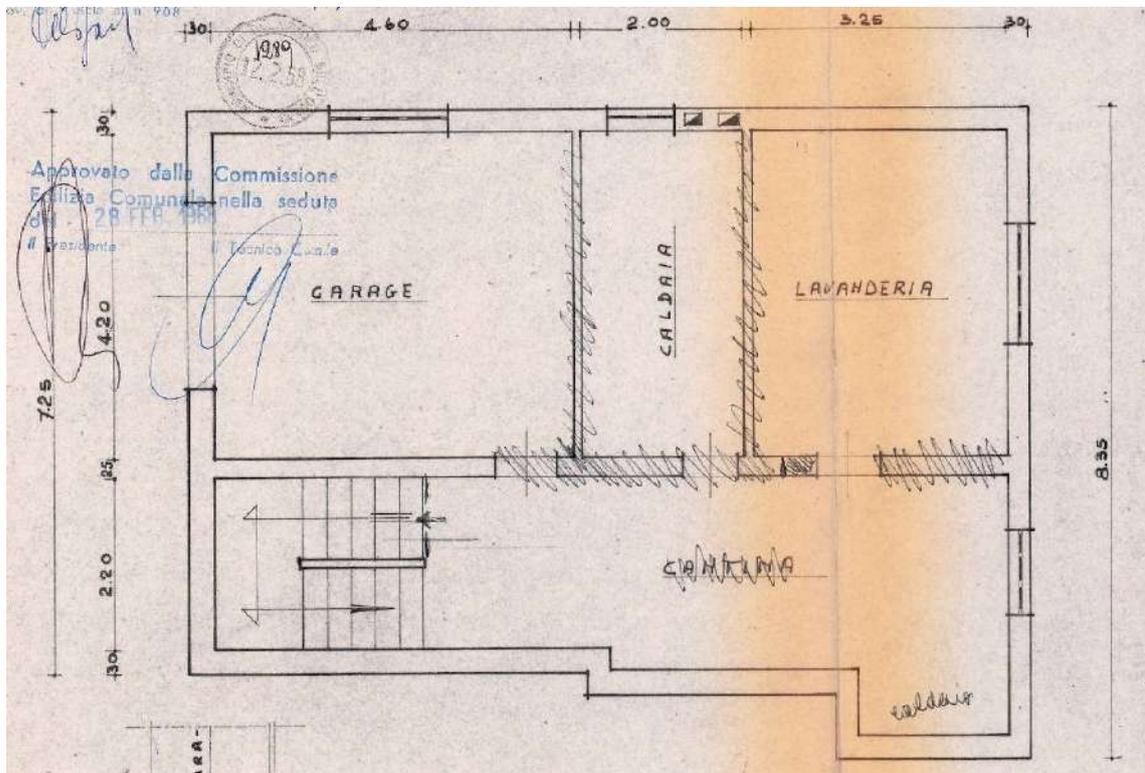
Licenza di Costruzione n. 1289 del 04.03.1968 - pianta piano seminterrato
